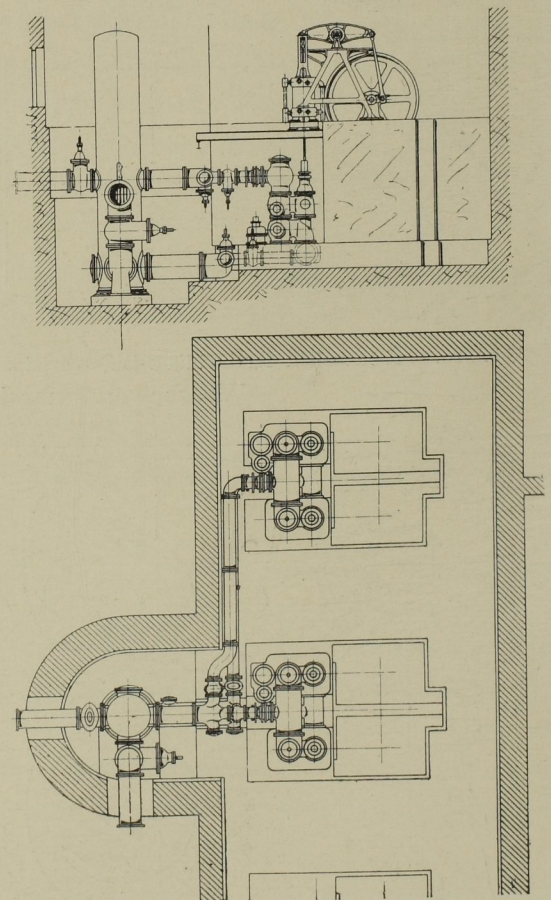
Grundriss der Anlage. Rohrplan. Masst. 1:250.
